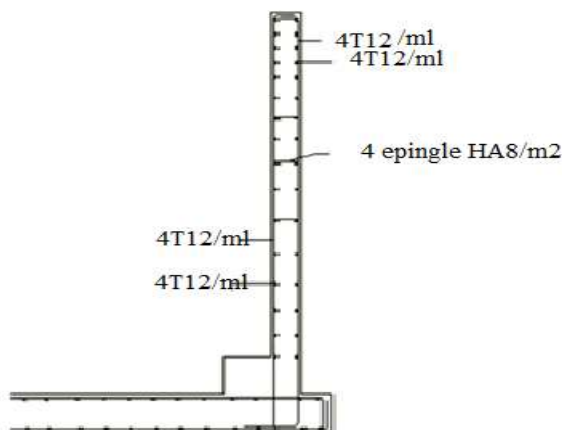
Croquis de ferrailage du mur de soutènement
